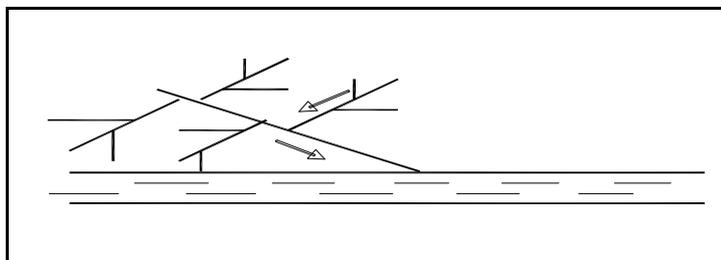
Schéma à Collecteur Transversal ou Oblique.
